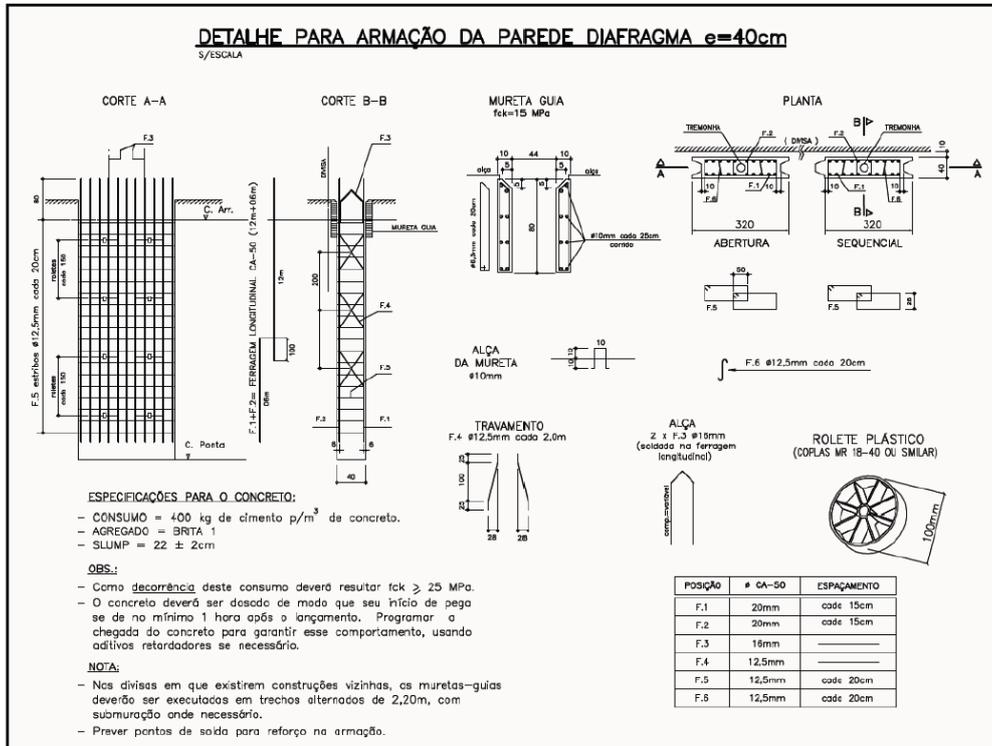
Detalhes de Armação e Concreto da Parede Diafragma.
